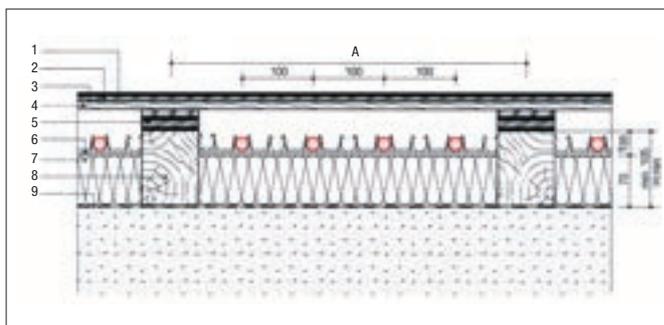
Struttura del riscaldamento pavimento flettente
